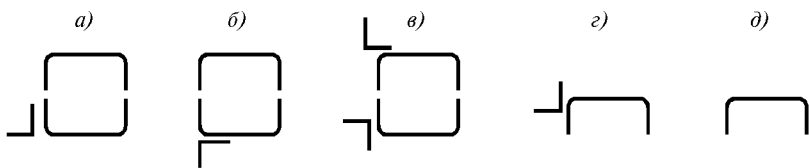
Сечения ригелей фахверка стен из трехслойных металлических панелей
